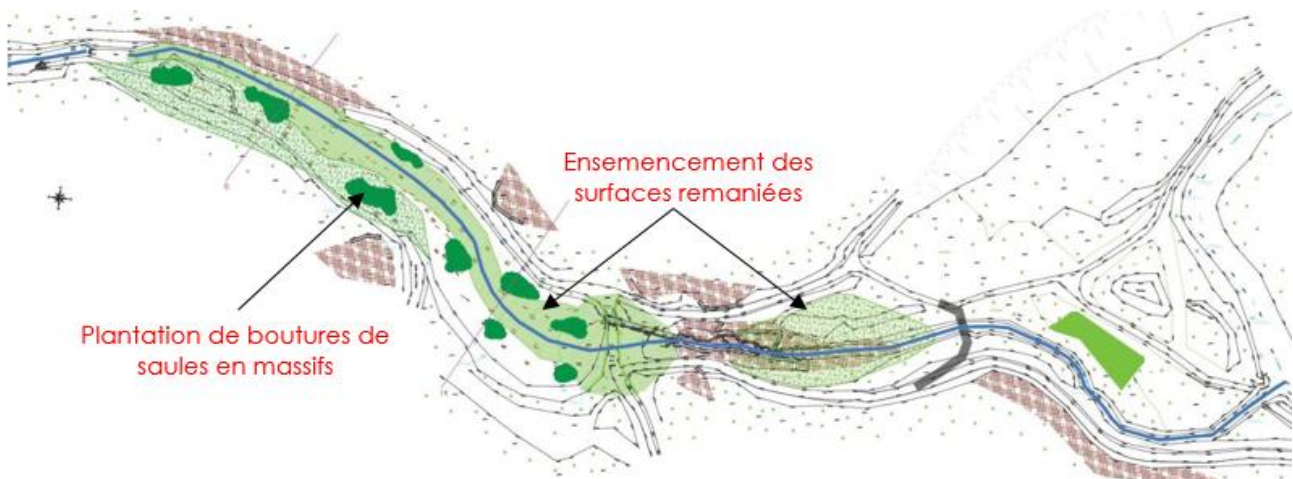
extrait du plan des travaux de phase 1 – étape 4
